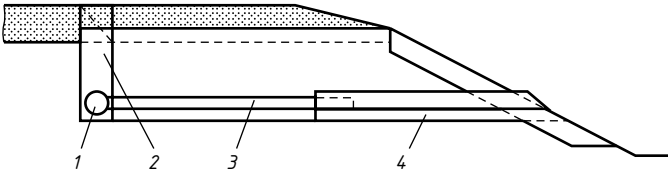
Осушение дренирующего песчаного слоя продольными дренами: 1 — продольная дрена; 2 — геотекстиль; 3 — поперечная дрена; 4 — насадка
